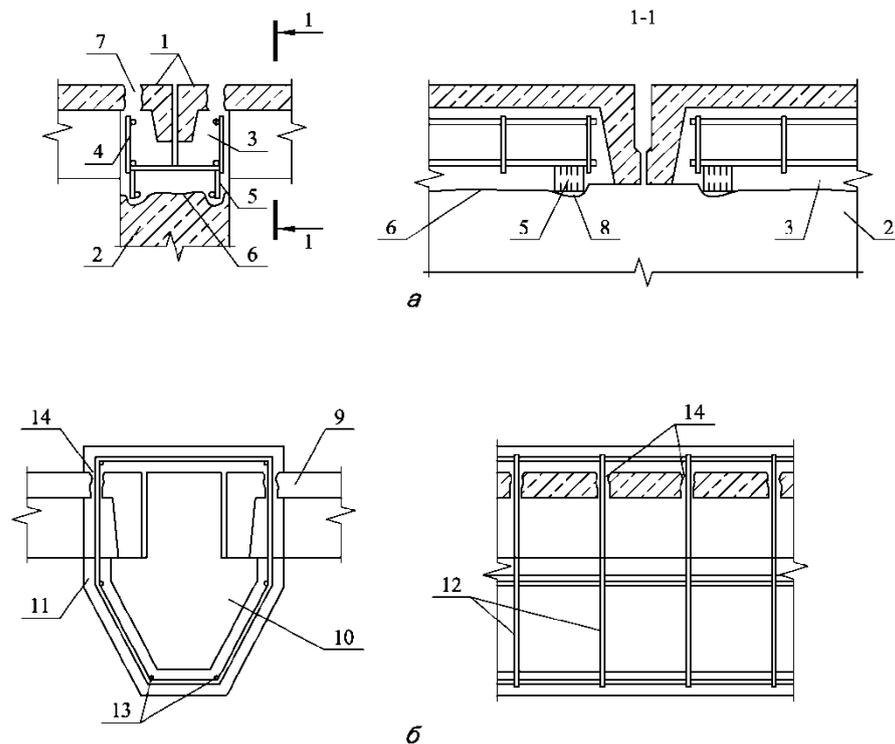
Схемы усиления конструкций путём включения в совместную работу других элементов: а – плит покрытия со стропильными конструкциями; б – плит перекрытия с ригелем; 1 – плиты покрытия; 2 – стропильная конструкция; 3 – бетон омоноличивания; 4 – дополнительный каркас; 5 – металлические пластины; 6 – подготовленная к бетонированию поверхность стропильной конструкции; 7 – отверстия в полках плит для укладки бетона; 8 – обнажённая арматура; 9 – плиты перекрытия; 10 – ригель; 11 – бетон омоноличивания; 12 – поперечные замкнутые хомуты; 13 – продольная арматура обоймы; 14 – отверстия в полках плит для пропуска хомутов и подачи бетона
